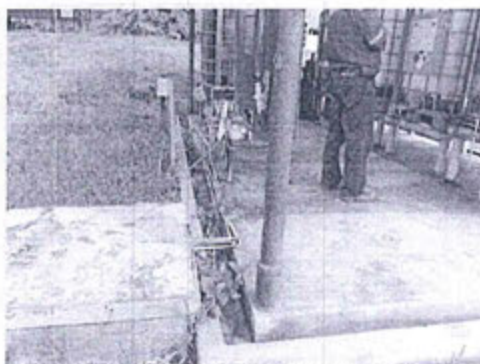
E349083 N9681478 (PSAD 56) / Locación del pozo Tambo 01
